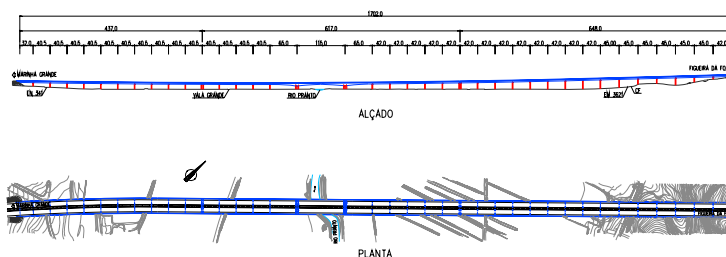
Alçado e planta ponte sobre o rio Pranto.
